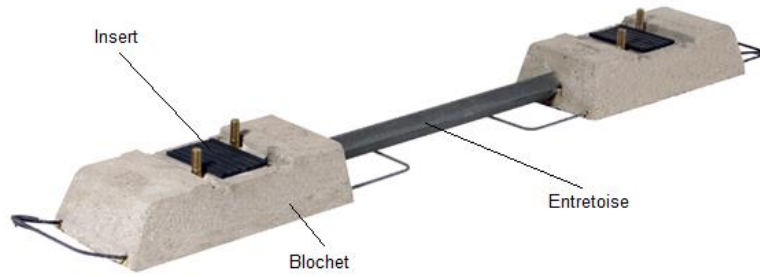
Exemple de traverse béton bi-bloc STRAM 120 STRADAL
